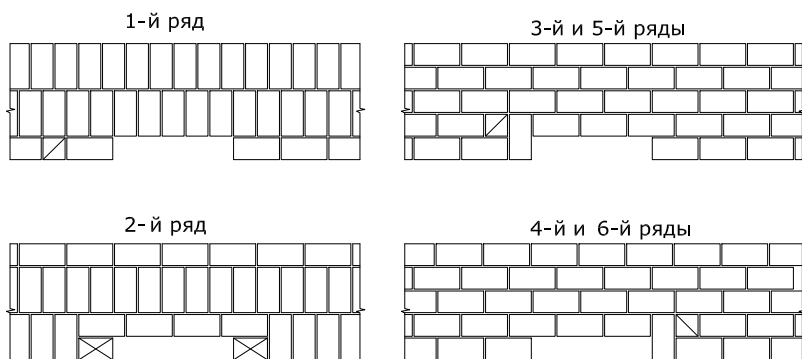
Кладка стены с нишей при многорядной системе перевязки
